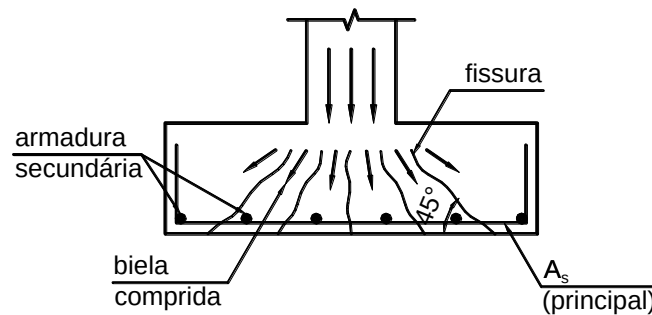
Armaduras, biela de compressão e fissuração na sapata corrida.
